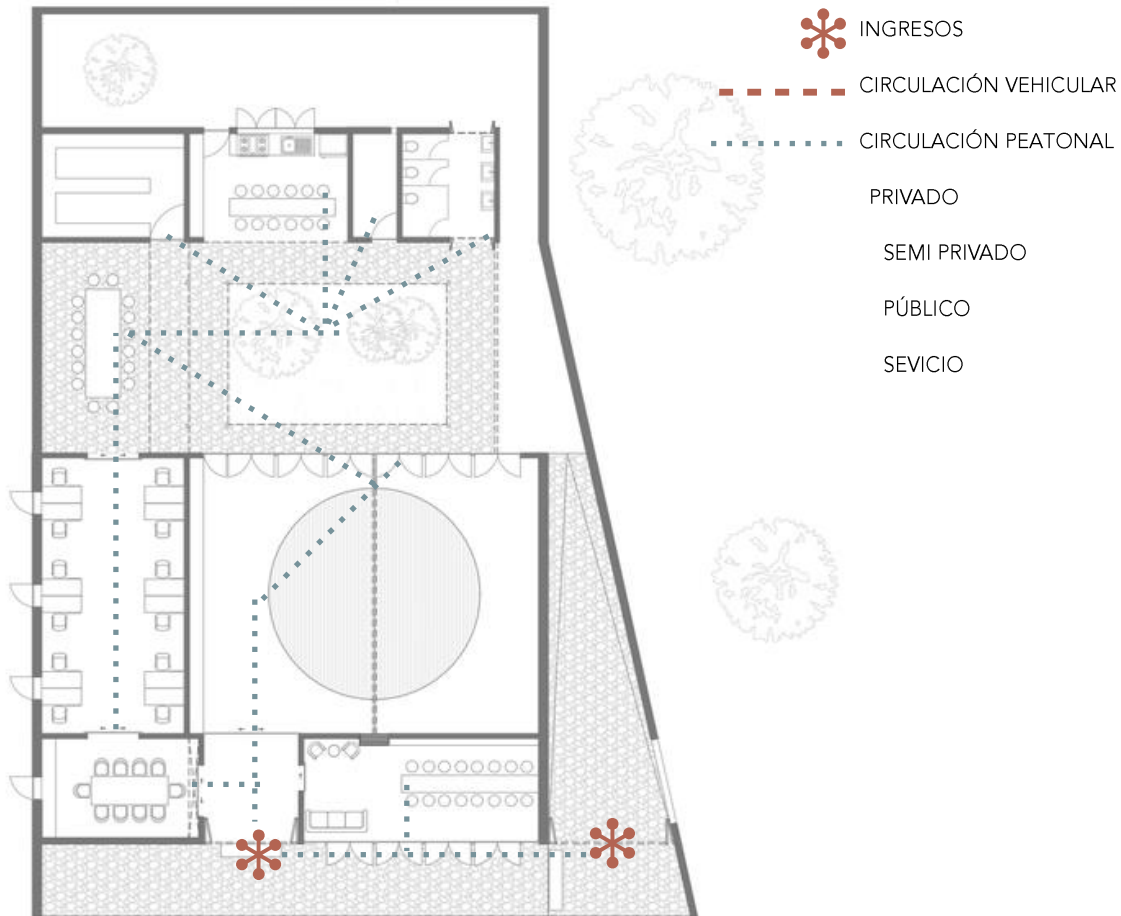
Plano de planta nivel 1, zonificación por áreas. Fuente: elaboración propia. Imagen tomada de sitio web <https://www.archdaily.mx>
